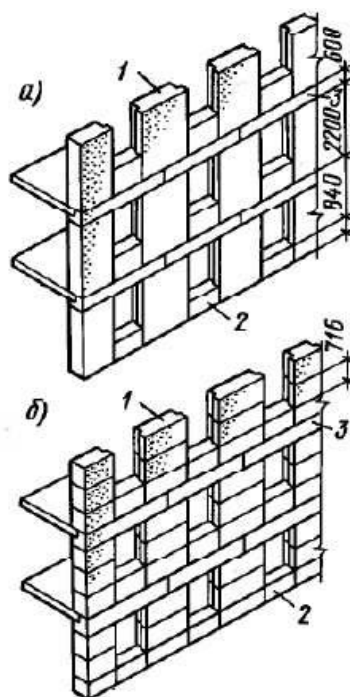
Схемы разрезки стен крупноблочных зданий: а — двухрядная, б — четырехрядная, 1 — простеночный блок, 2 — подоконный блок, 3 — блок-перемычка
